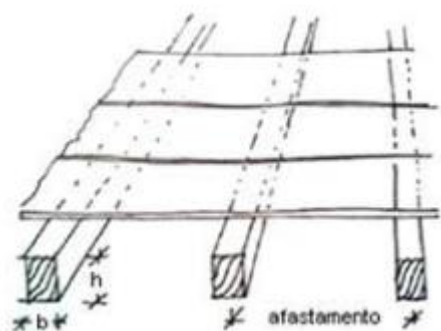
Secções transversais e afastamentos das vigas (Martins; 2010)
